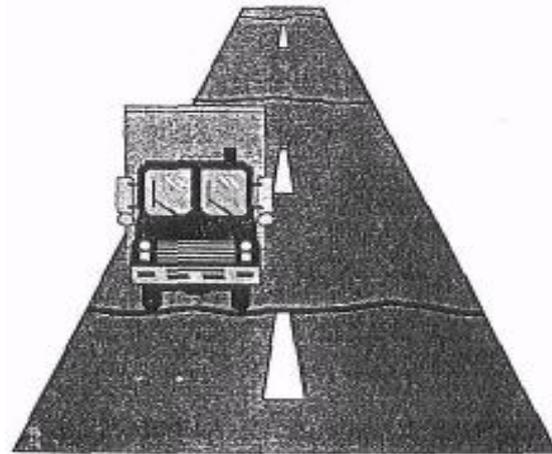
(Fisuramiento por baja temperatura)
